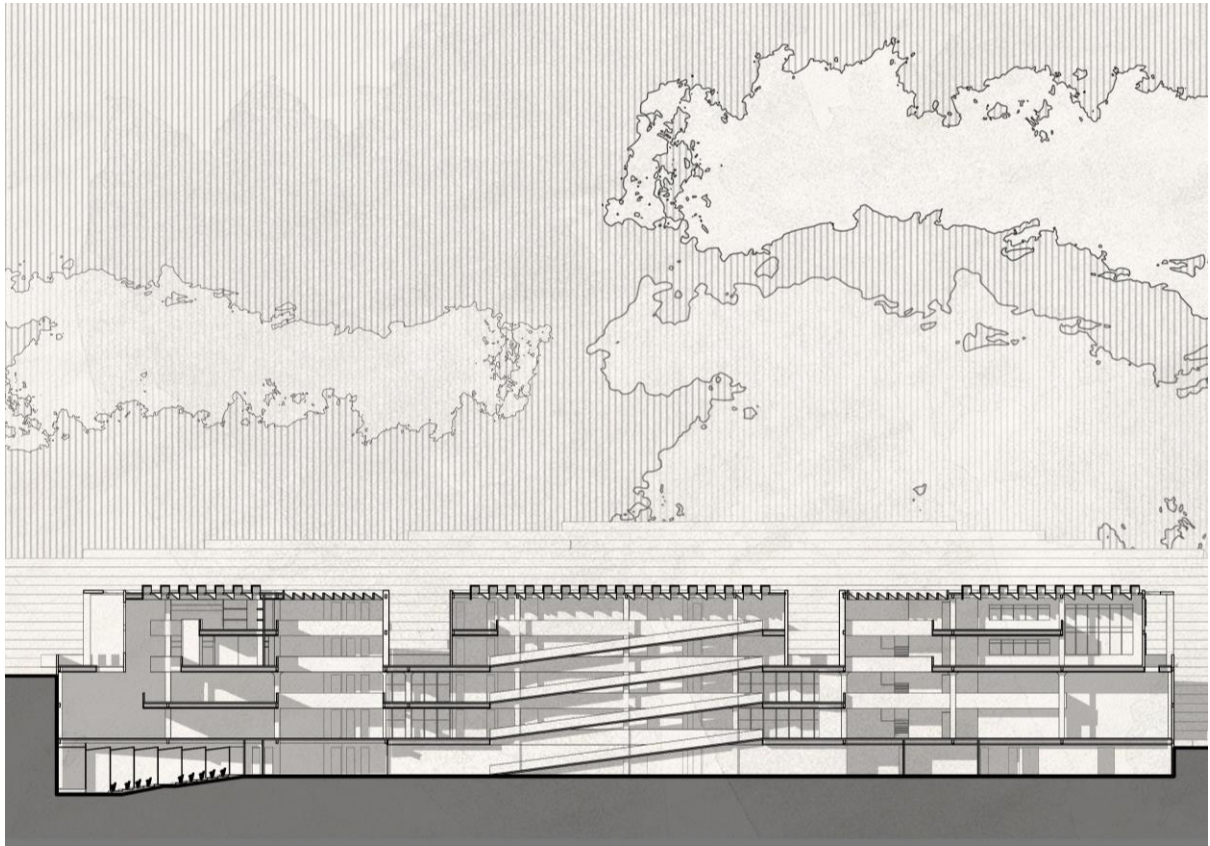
Corte Longitudinal fugado. Elaboración Propia
